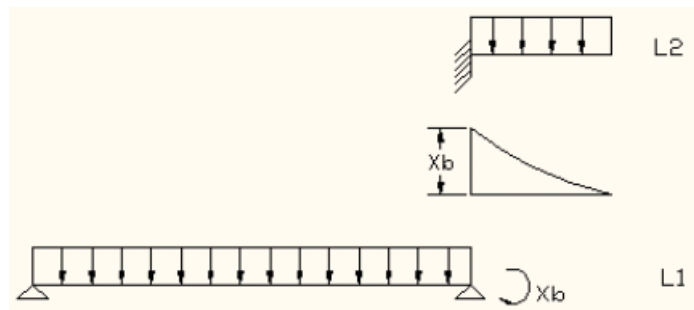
Momento fletor gerado na laje em balanço com estrutura engastada na laje interna
